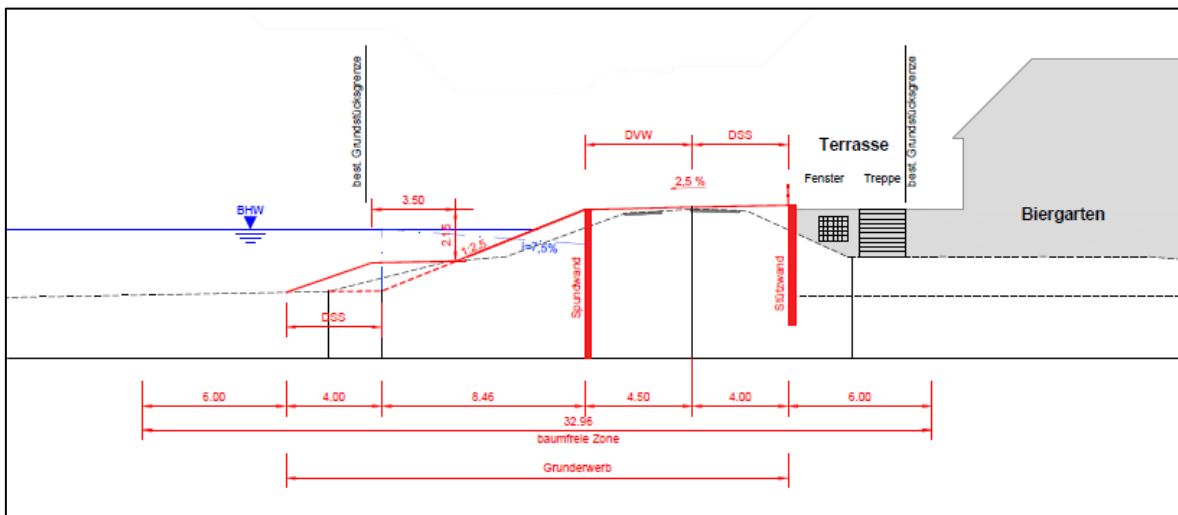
Dammprofil Damm-km 0+880,00 Biergarten
